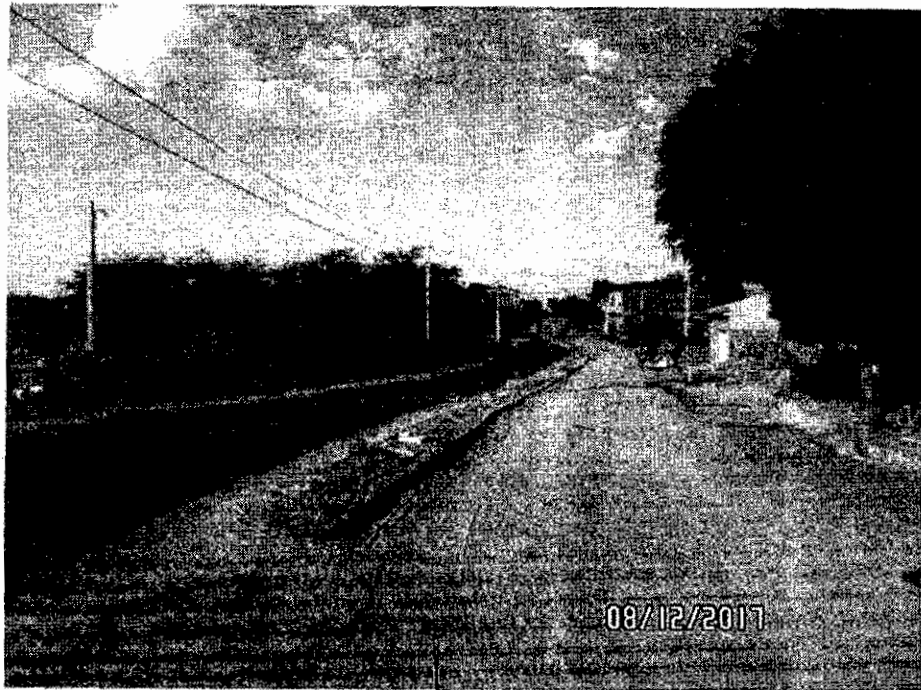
TRECHO DA PAVIMENTAÇÃO
